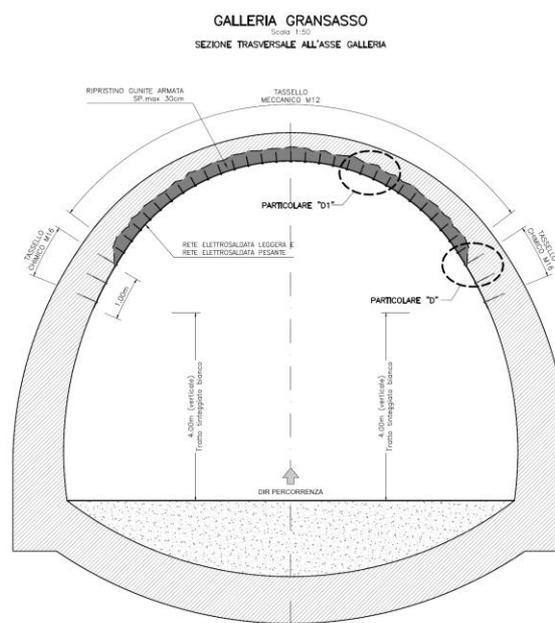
Rappresentazione tipologico C3B su sezione trasversale galleria
